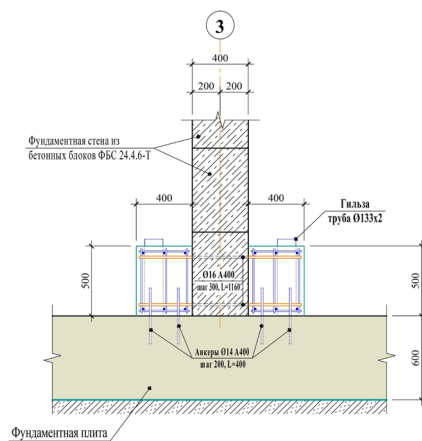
Усиление фундаментной плиты железобетонными балками вдоль внутренней поперечной стены по оси 3 на участке в осях Д-И (см. рис. 3 цв. вклейки)
